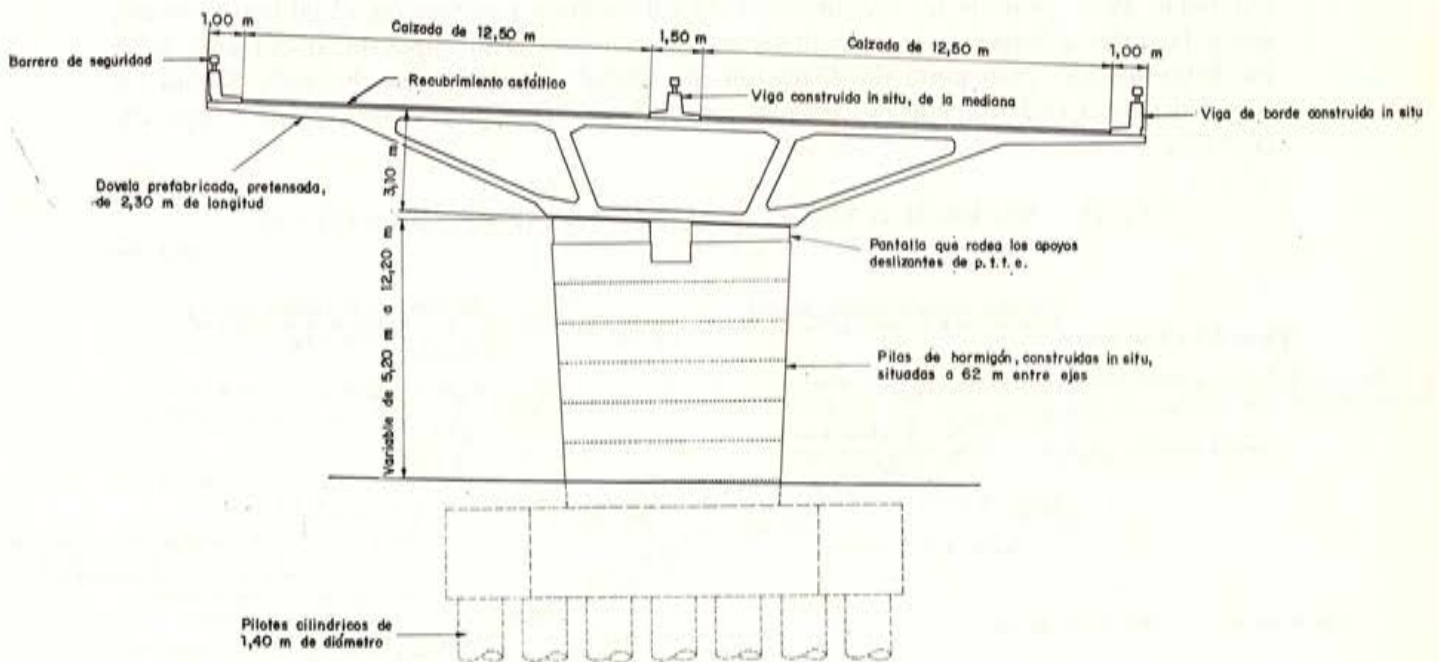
Paso elevado de Westway, en Londres. Sección transversal de la viga principal, construida por dovelas.
